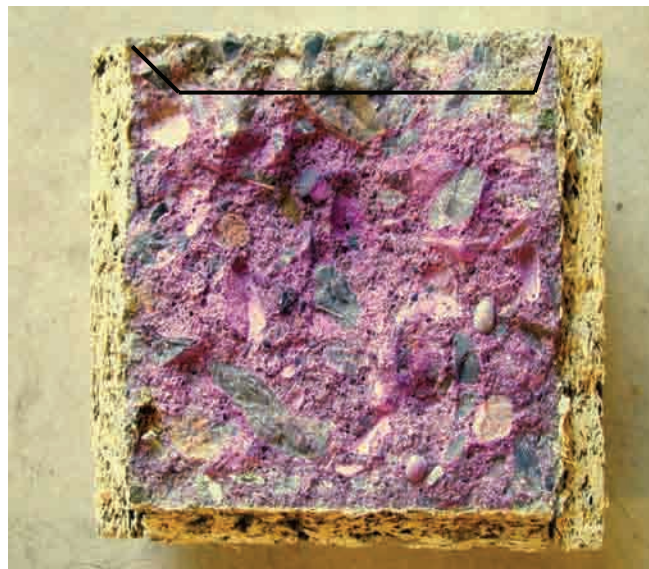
1 コンクリート打放し 写真. 5. 2 木毛セメント板打込み
